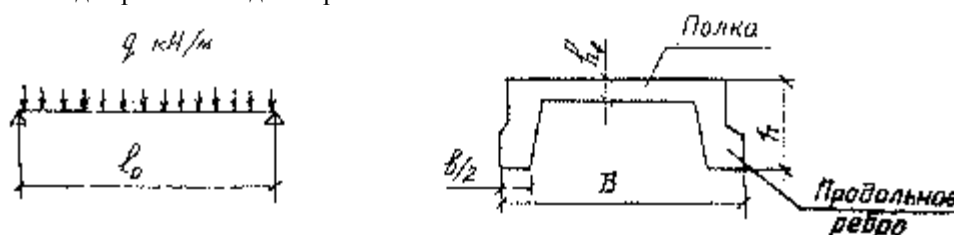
Расчетная схема и поперечное сечение ребристой плиты
